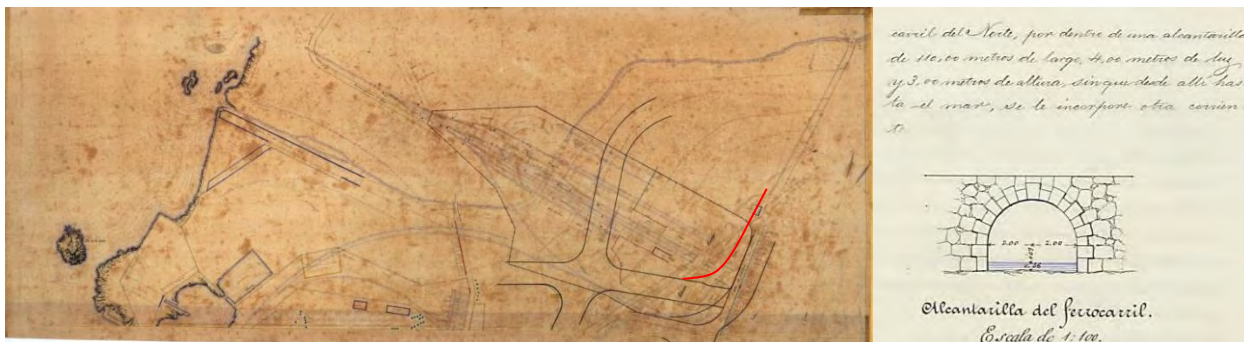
Imagen de la izquierda: Canalización (marcada en rojo) del Arroyo de la Gaitera bajo la Estación del Norte. Plano general nº 2 de Barón y Yáñez. (1879). Ayuntamiento de A Coruña. Imagen de la derecha: Proyecto de Muro y Terraplén sobre la Playa de San Diego. Eduardo Vila y Algorri. (1914). Autoridad Portuaria de A Coruña.
